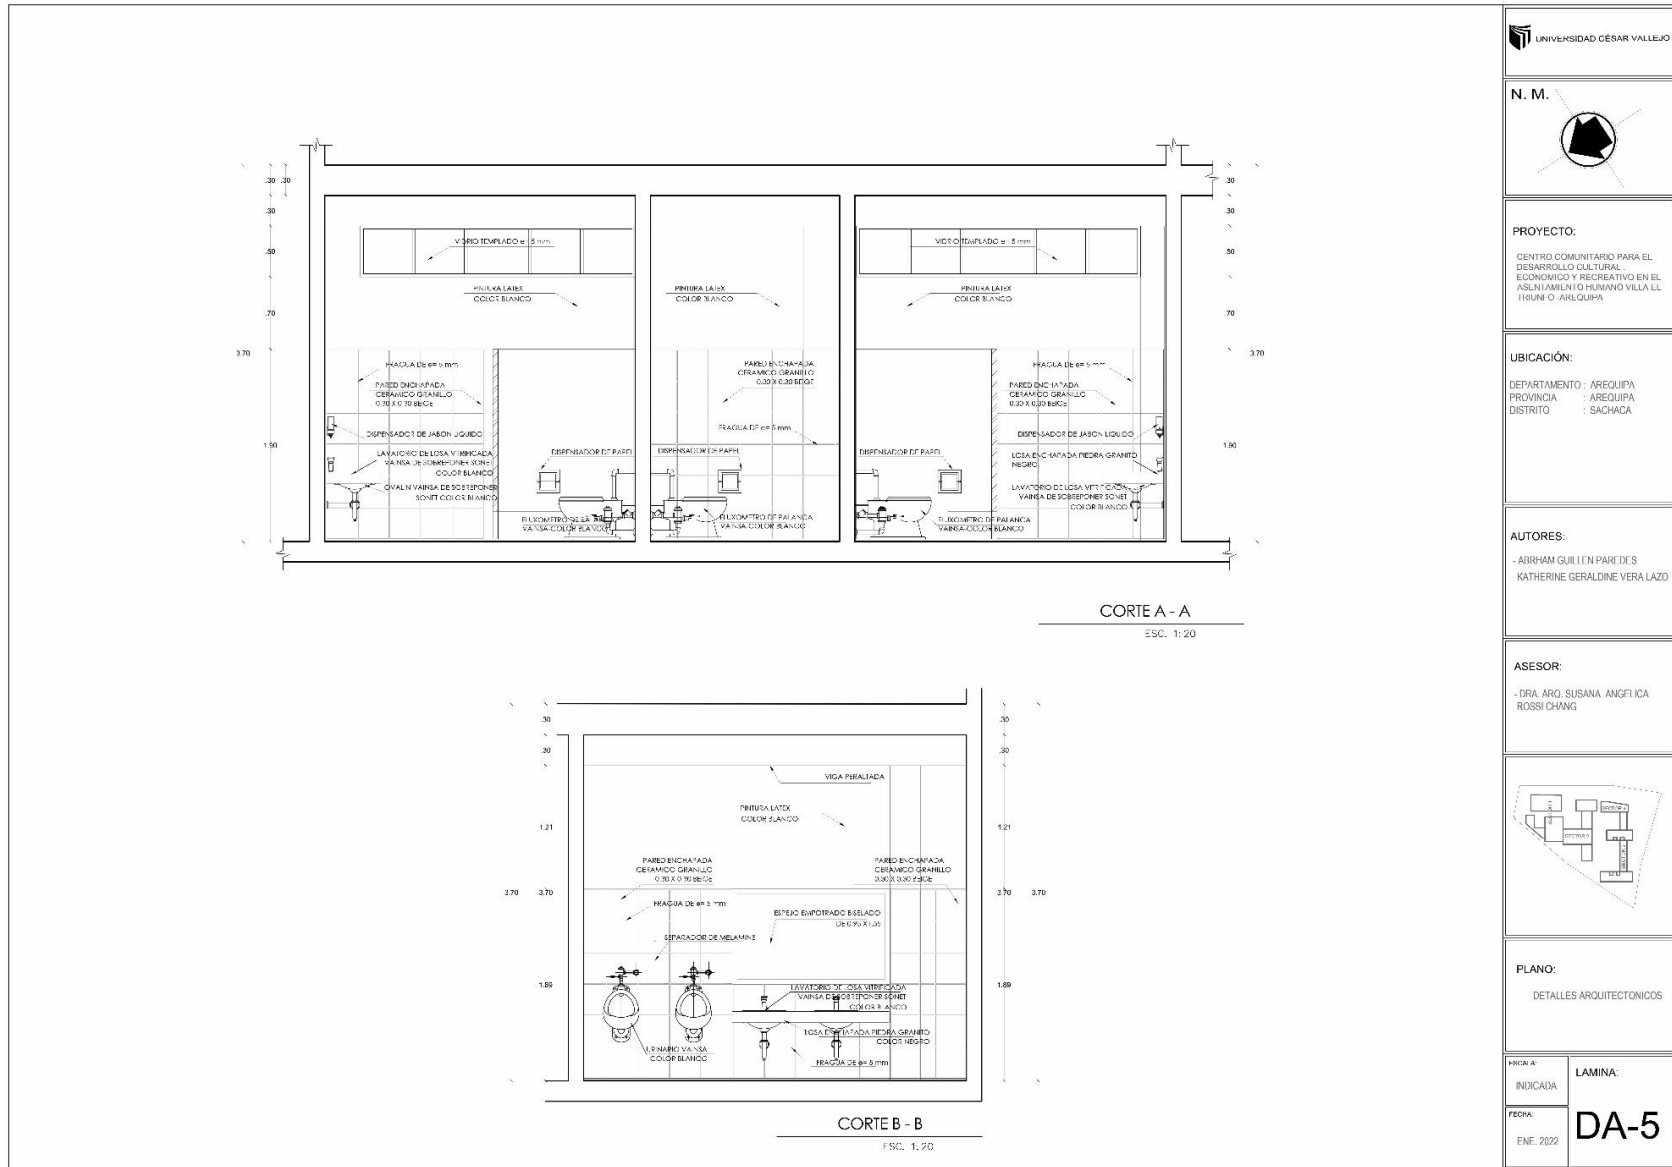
Plano de Detalles Arquitectónicos (Secciones - Baño Biblioteca) - Elaboración propia
